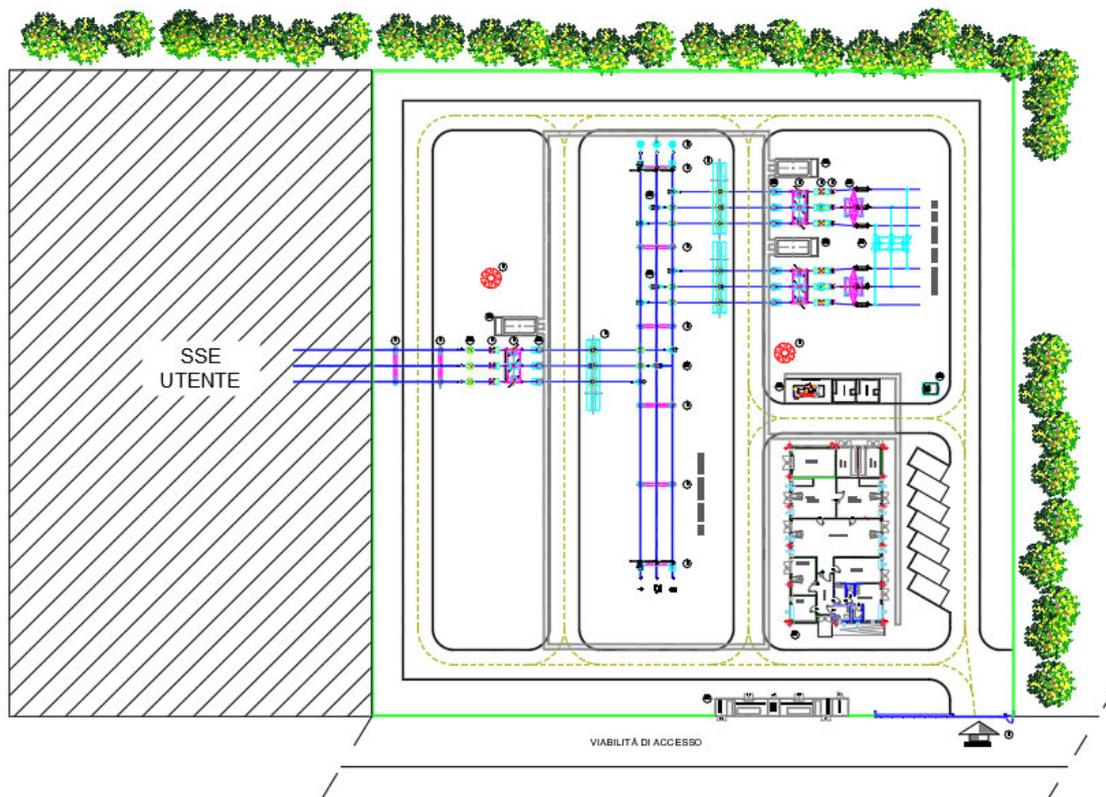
Planimetria Stazione Elettrica 132 kV di interconnessione alla RTN – Terna
